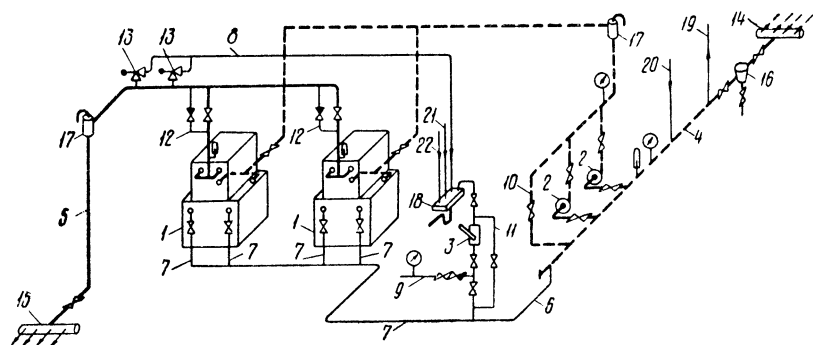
Полная тепловая схема котельной установки с водогрейными чугунными секционными котлами для системы отопления с насосной циркуляцией воды
